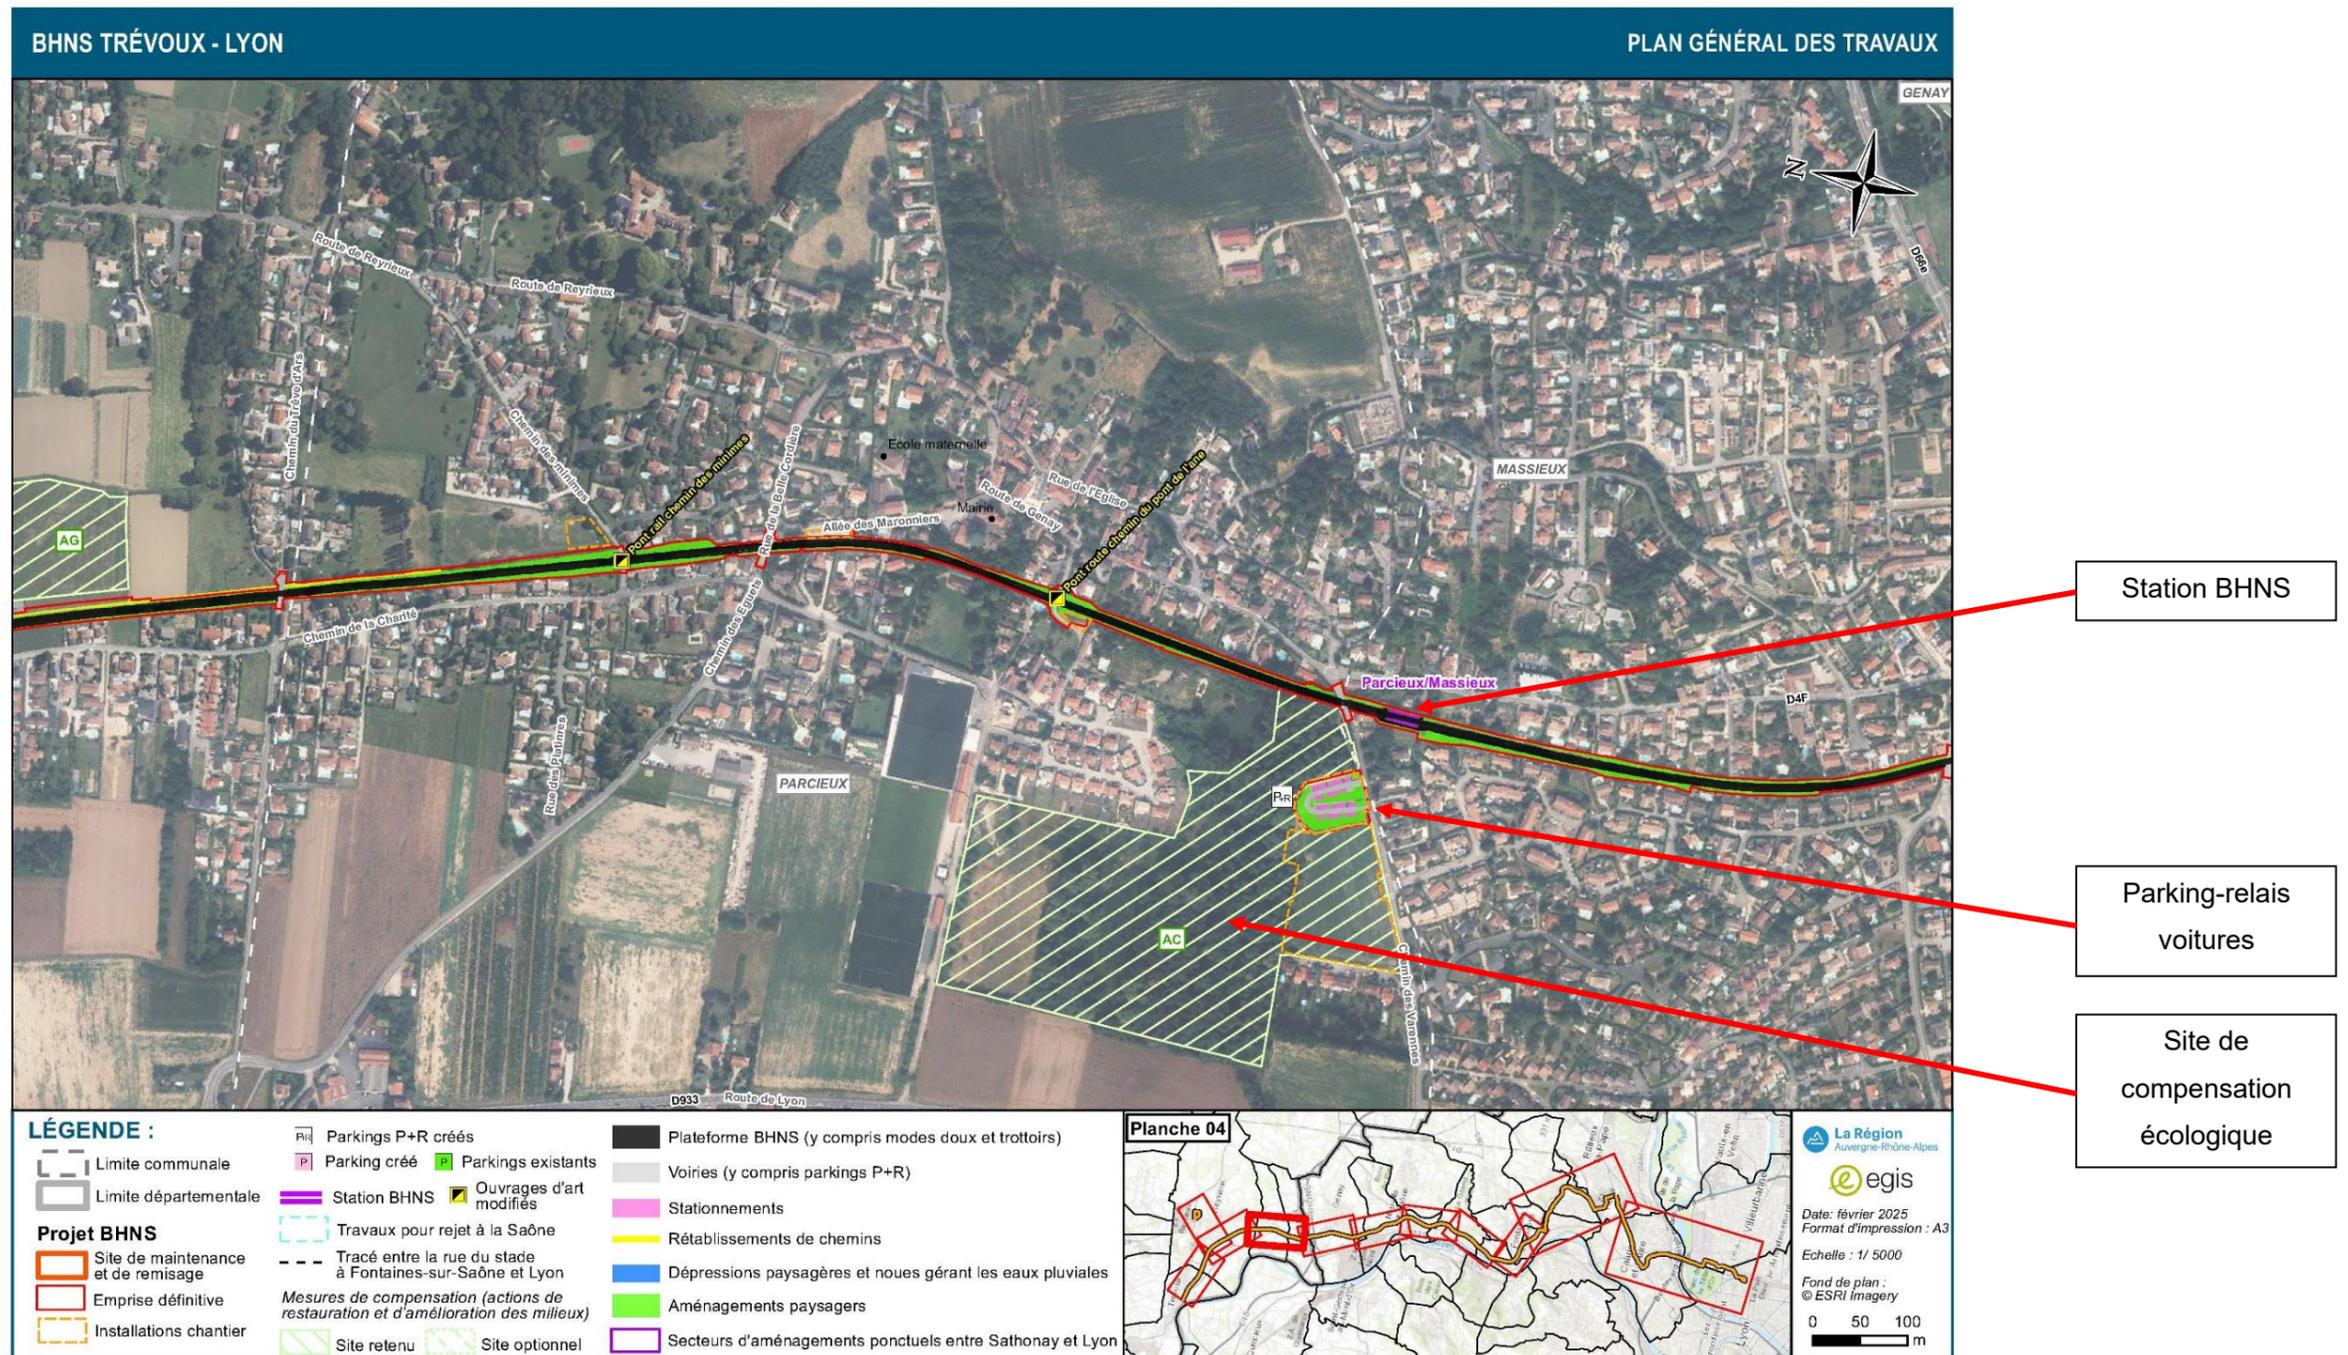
Extrait du plan général des travaux sur la commune de Parcieux
